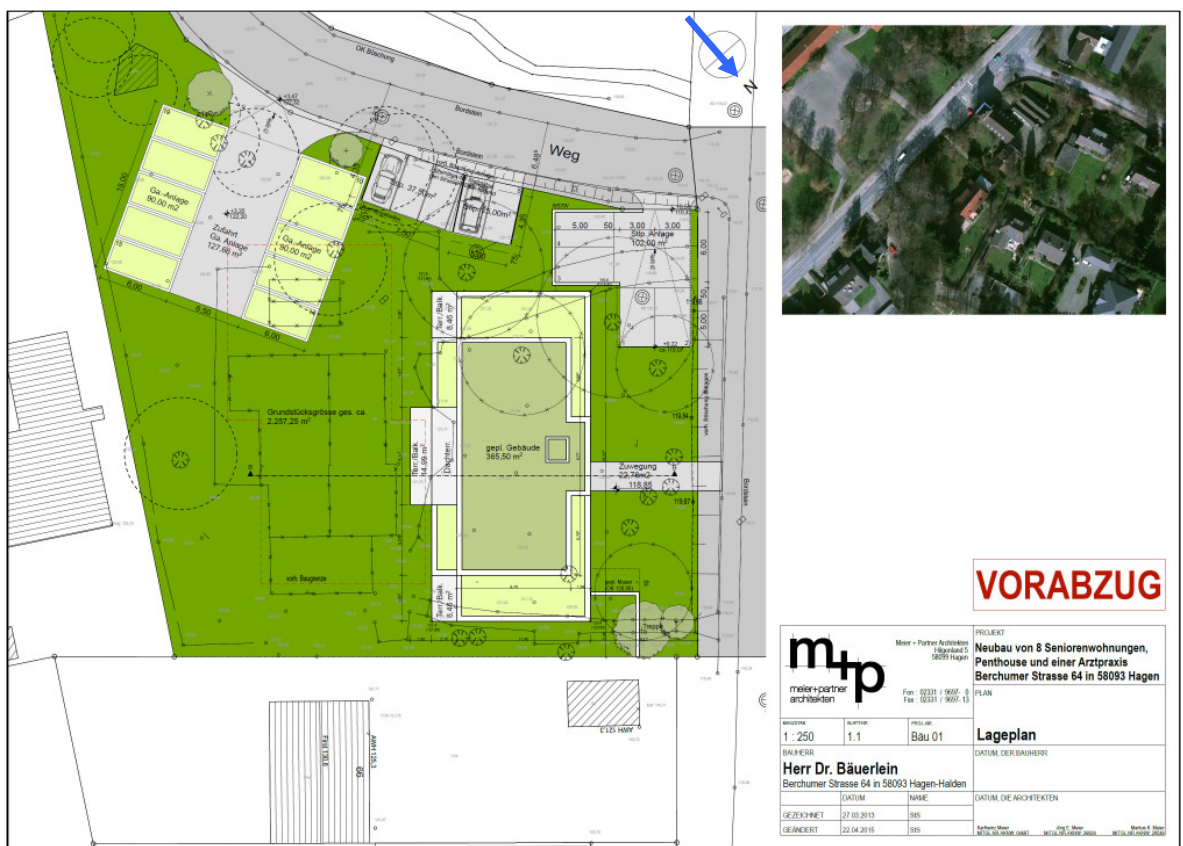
Lageplan des geplanten Wohn- und Geschäftshauses [7]
